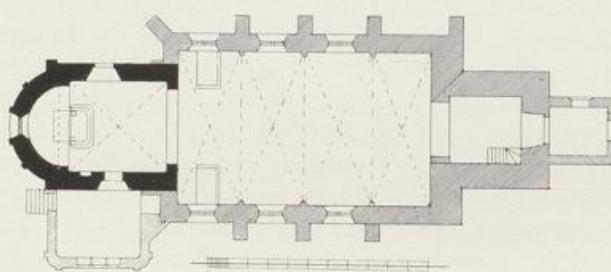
Soller. Grundriss der kathol. Pfarrkirche.
